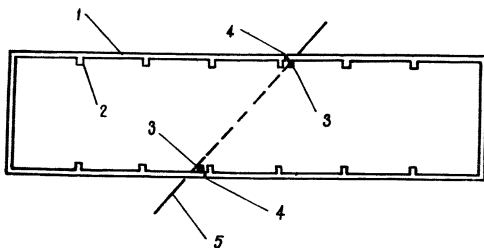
Схема разрезки на отсеки каменного бескаркасного здания с легким покрытием, расположенного под значительным углом к простиранию пластов:
